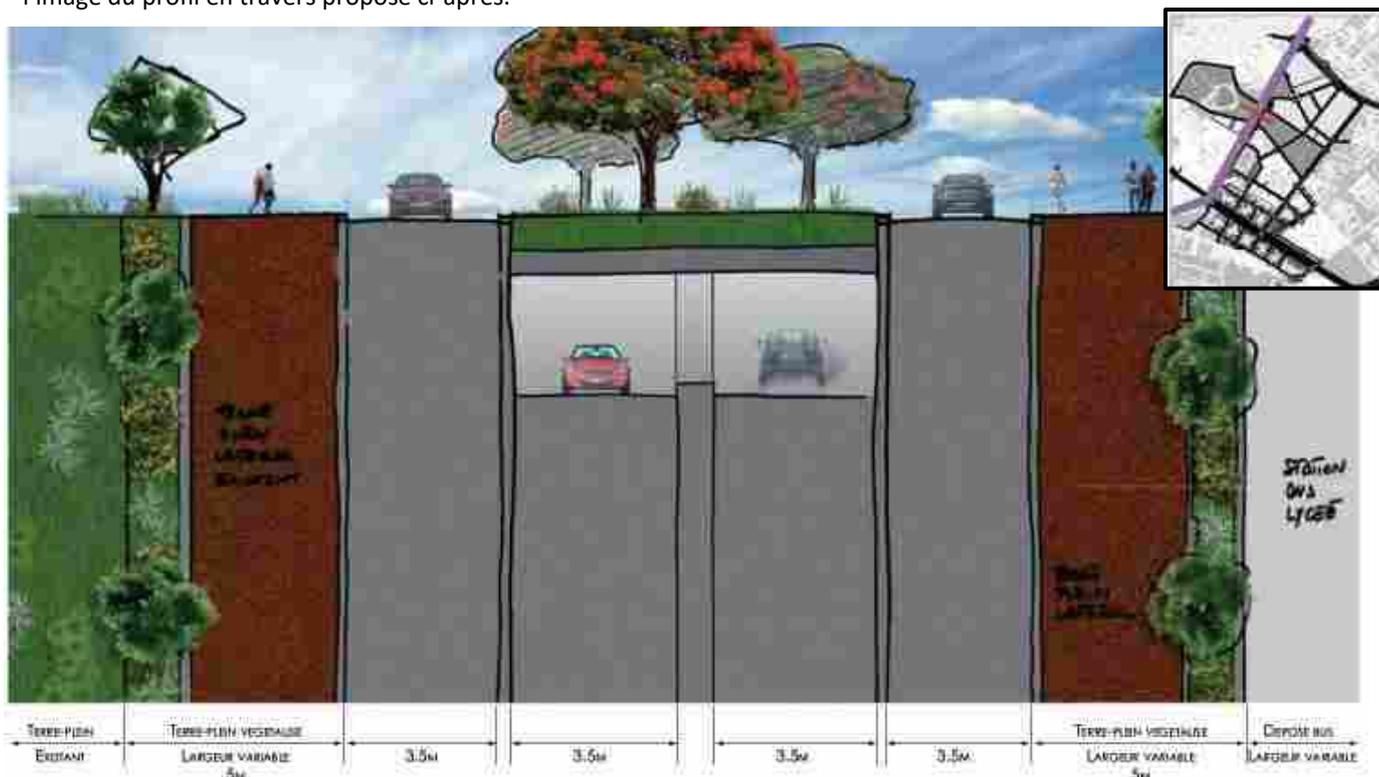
Profil en travers proposé pour la RN4a au droit du Parc Boisé existant
